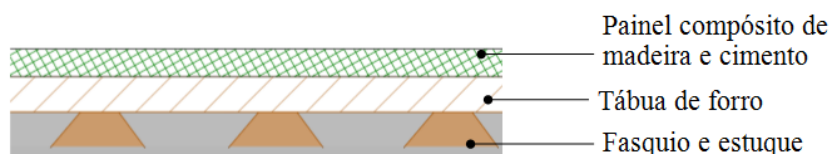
Esquema da solução 1 de laje de esteira (corte transversal) e legenda
